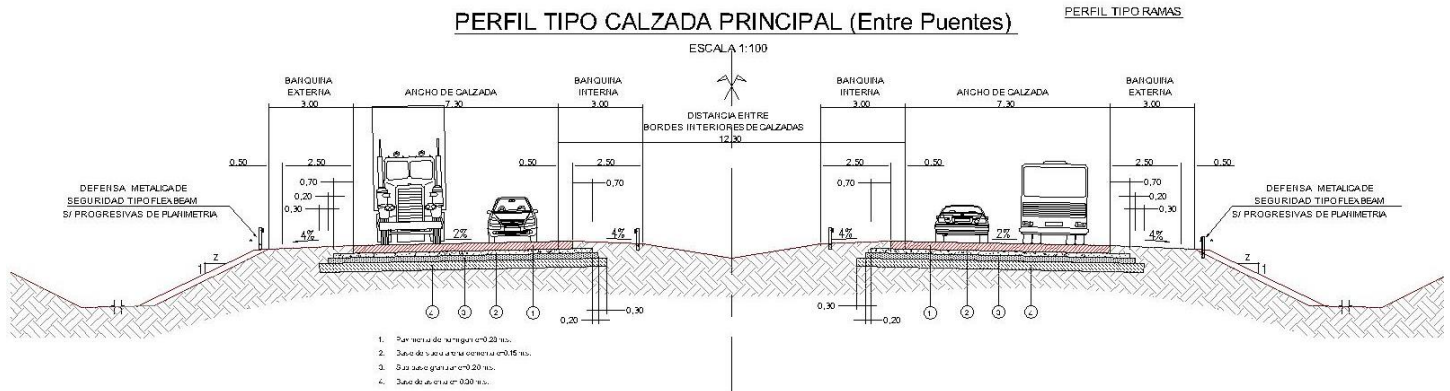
Perfil Av. Cárcano entre Puentes.
